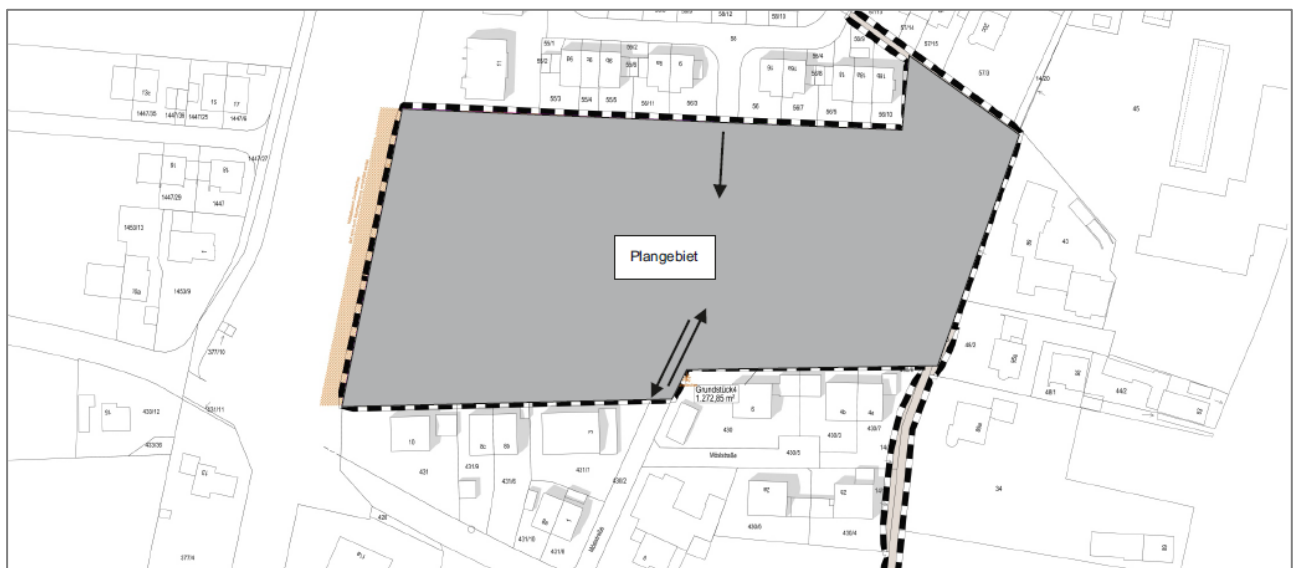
Erschließungsvariante VII, Plangrundlage: Planungsgruppe Strasser
